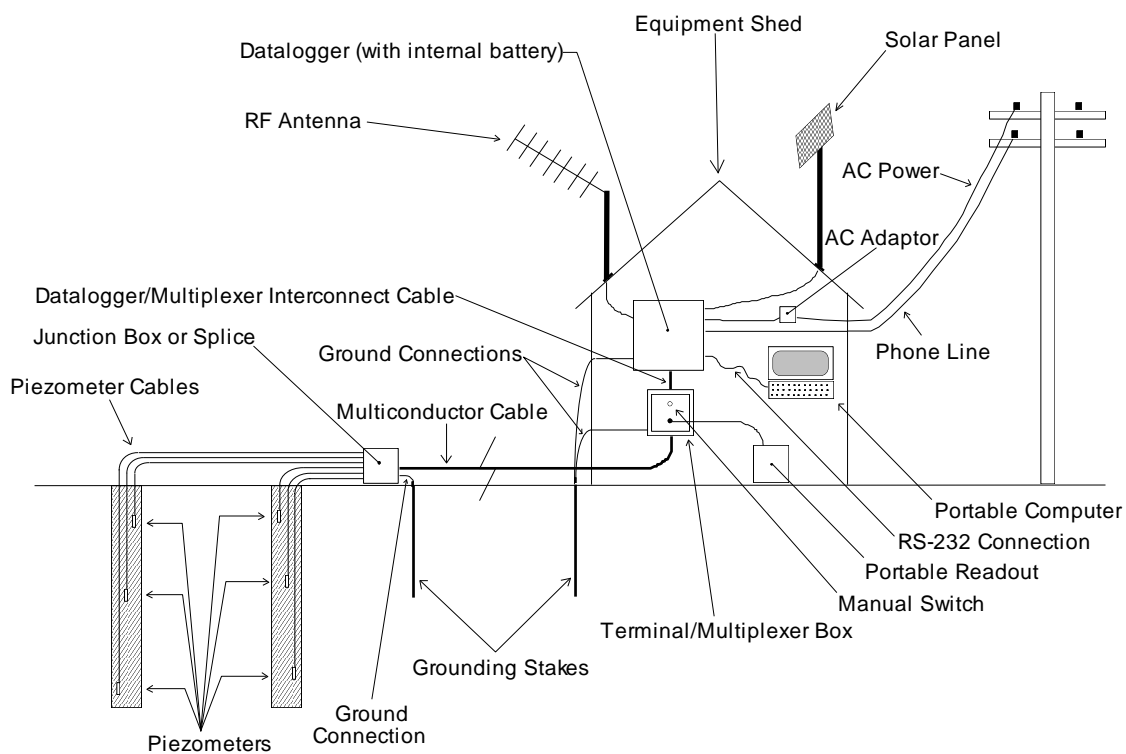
Instalación Típica de Piezómetros Múltiples
